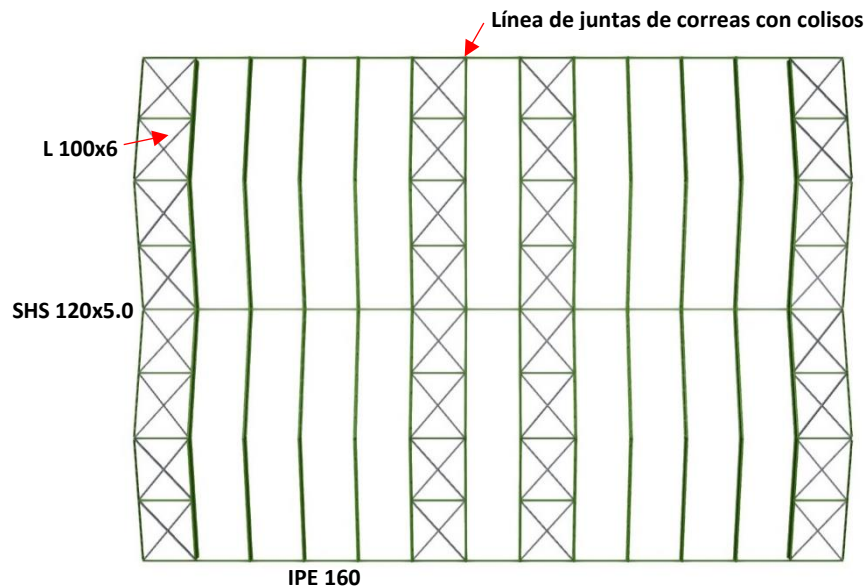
Cubierta. Fuente: CYPE 3D.
